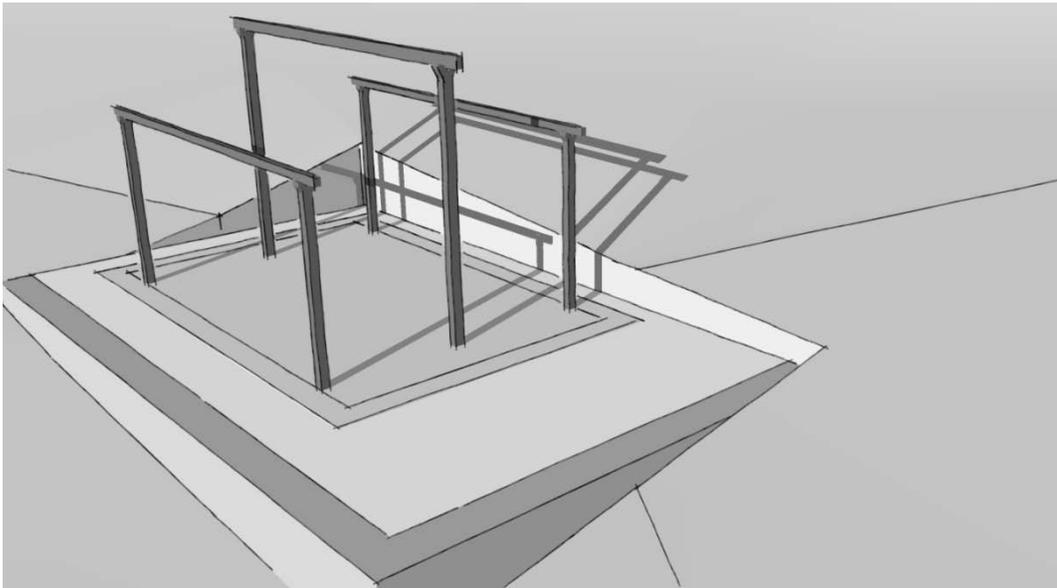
Colocación de los pilares y vigas madre (partida "Estructura").
